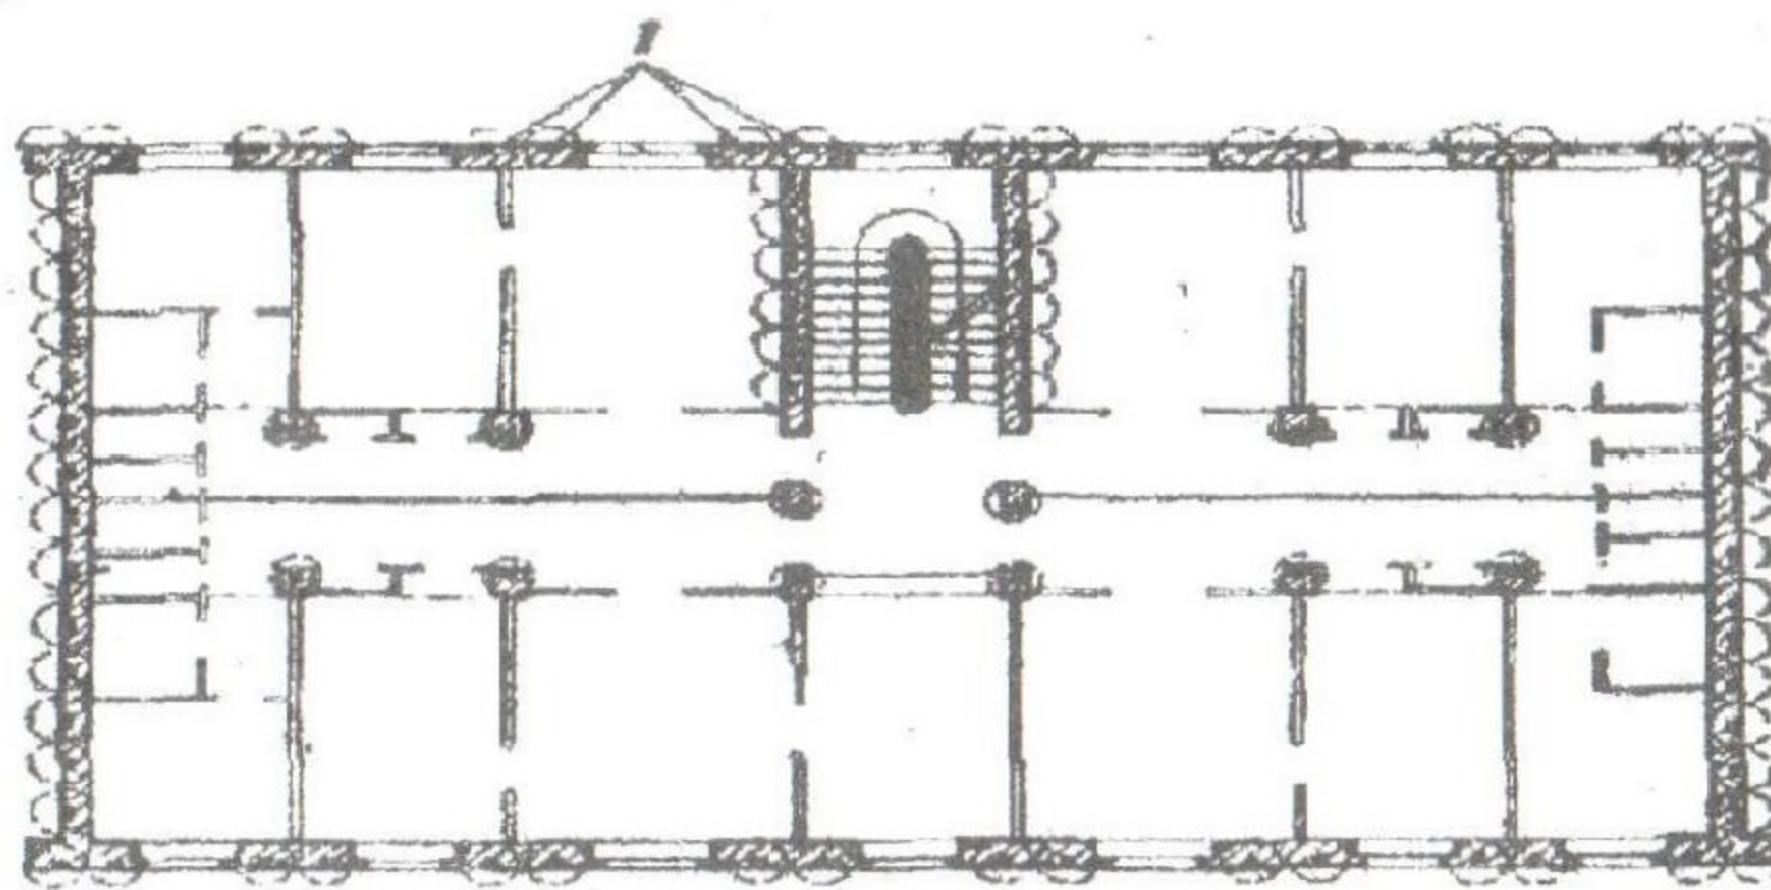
Обрушение секции здания на месте подрыванием всех капитальных стен и колонн:
